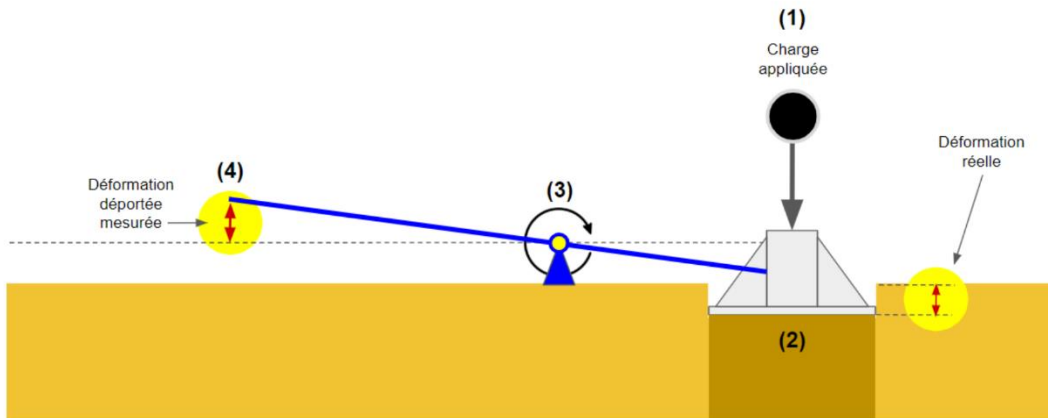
Schéma mise en place de l'essai de plaque. (photo :www.wikip.fr)
